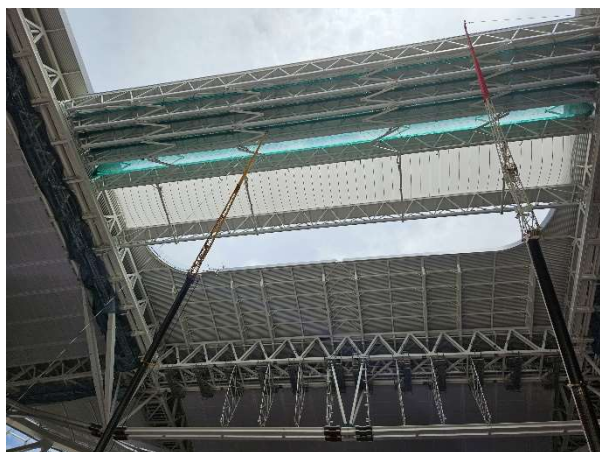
Vista de la cubierta retráctil en fase de pruebas. Vista del fondo norte.
